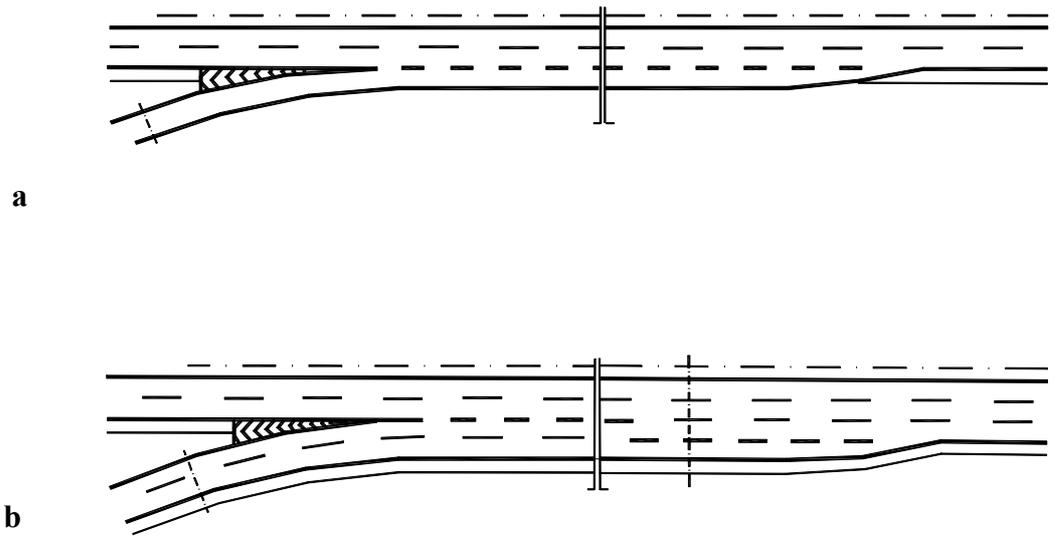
(a,b) – Schema geometrico delle rampe di immissione
